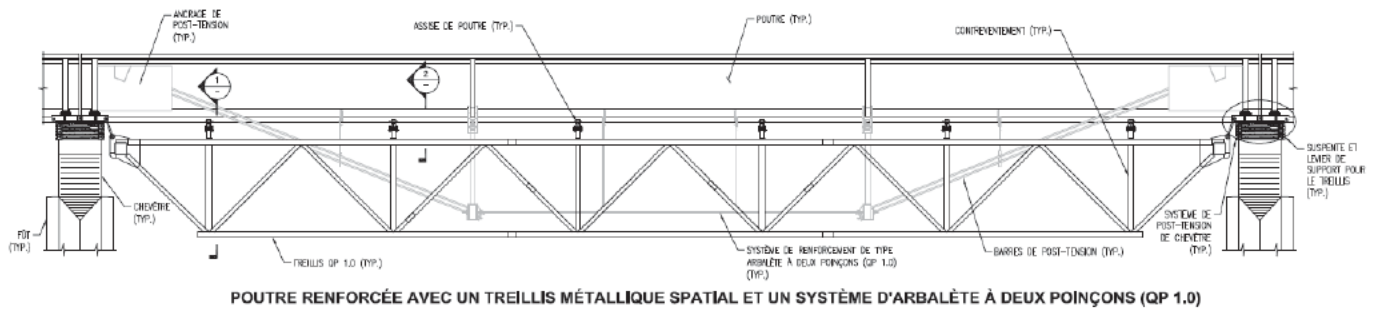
Poutres en béton – Renforcement par treillis modulaire pour QP1 (source : plans nomenclature PJCCI)
